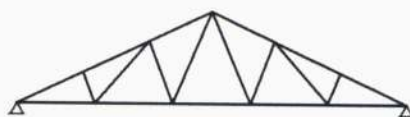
Treliça tipo Belga recomendadas para vãos entre 20 e 30 m. (Fonte: Próprio)
